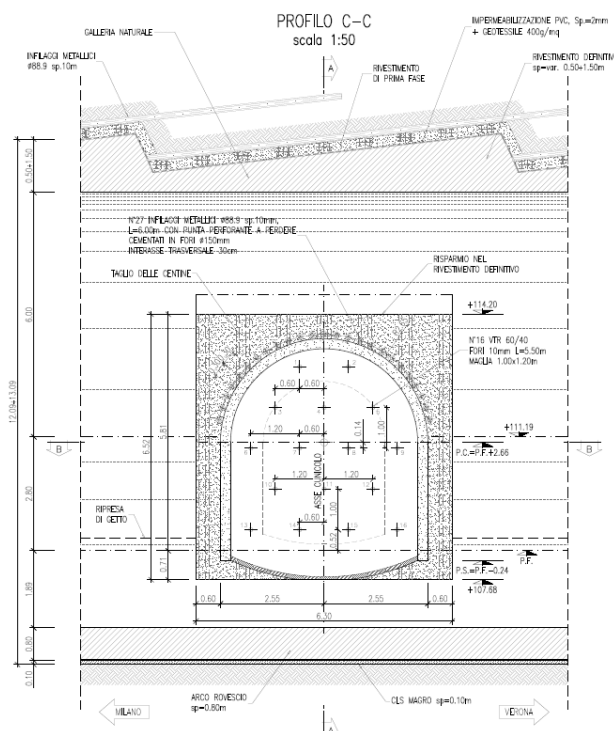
Profilo longitudinale della galleria naturale in corrispondenza del cunicolo di collegamento.
